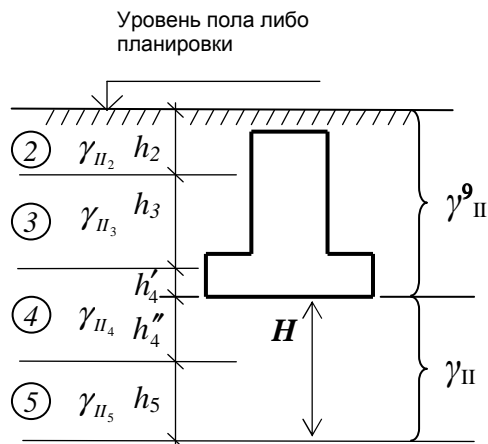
Схема к расчету удельных весов грунта, расположенных выше и ниже подошвы фундамента
